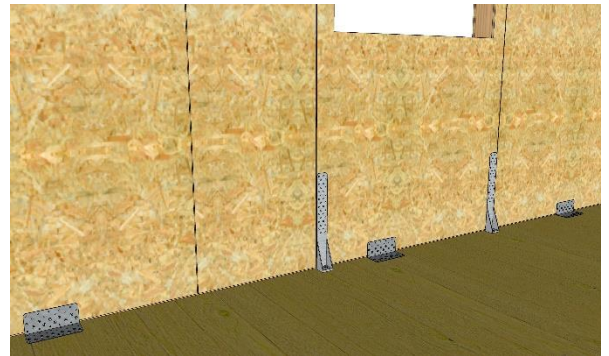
Mise en œuvre des équerres anti-soulèvement en pied de panneau de mur et en sous face de plancher
